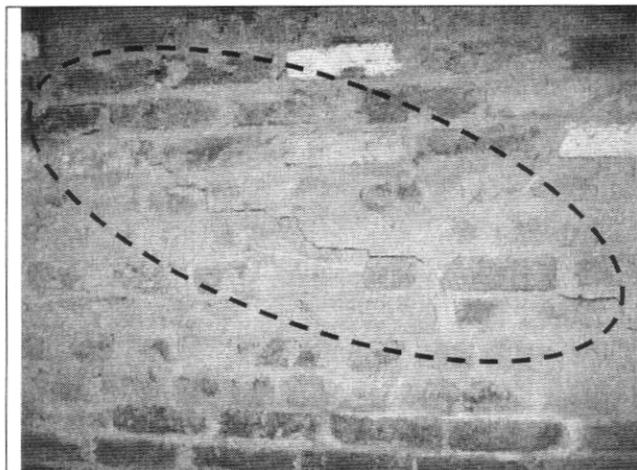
Se observan grietas diagonales en los muros con 2 cm de abertura y 3 metros de longitud aproximadamente
